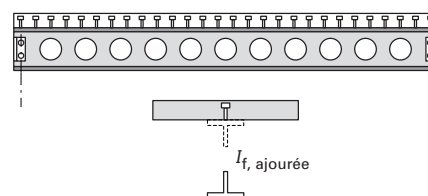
Inertie efficace des poutrelles mixtes ajourées
